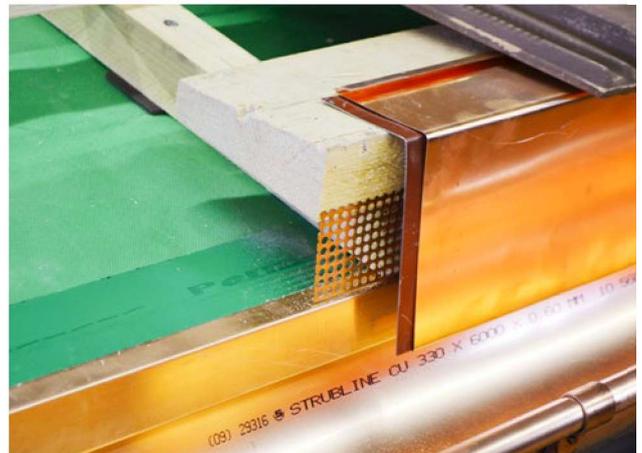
bavette servant de protection contre les UV et permettant la ventilation
